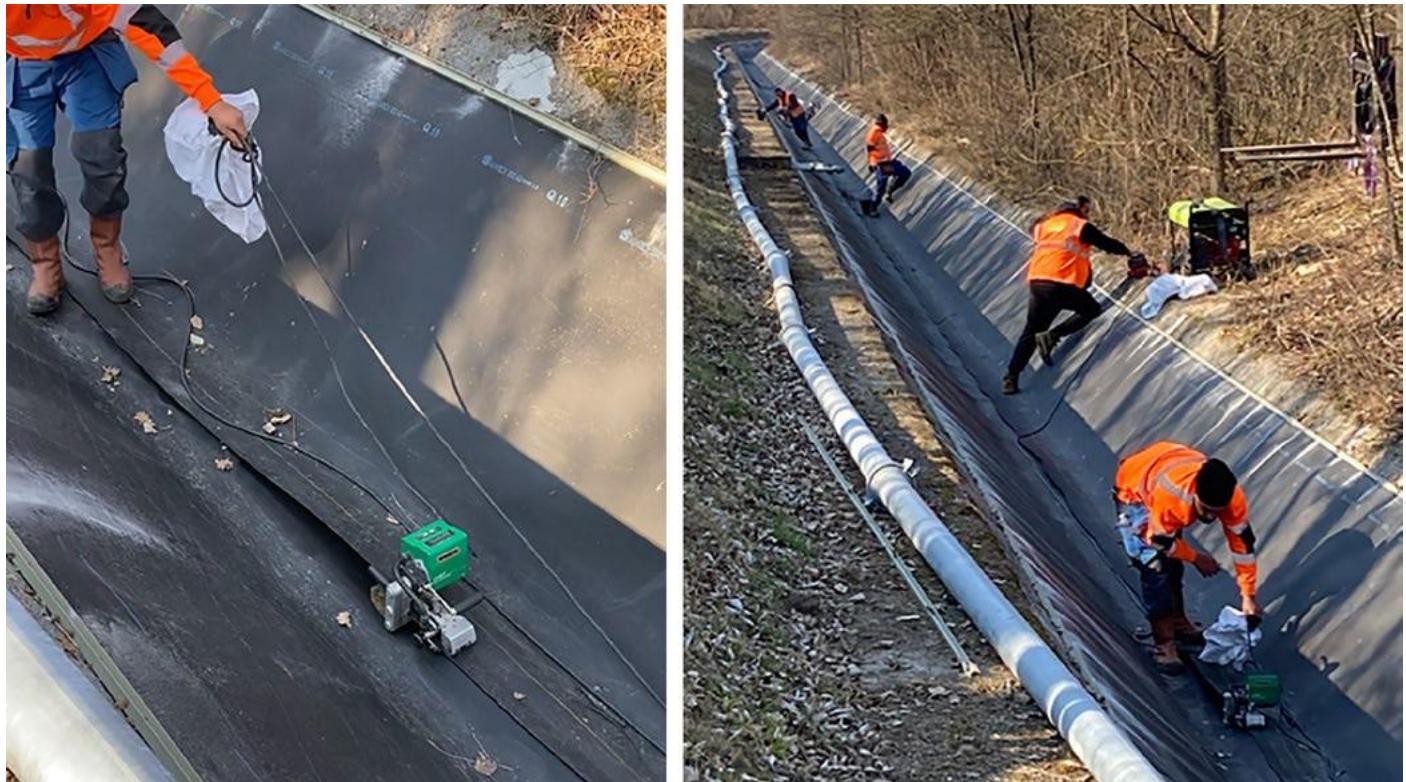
Réalisation des soudures longitudinales, transversales et fixation de l'ancrage longitudinal © BRGM, 2022
